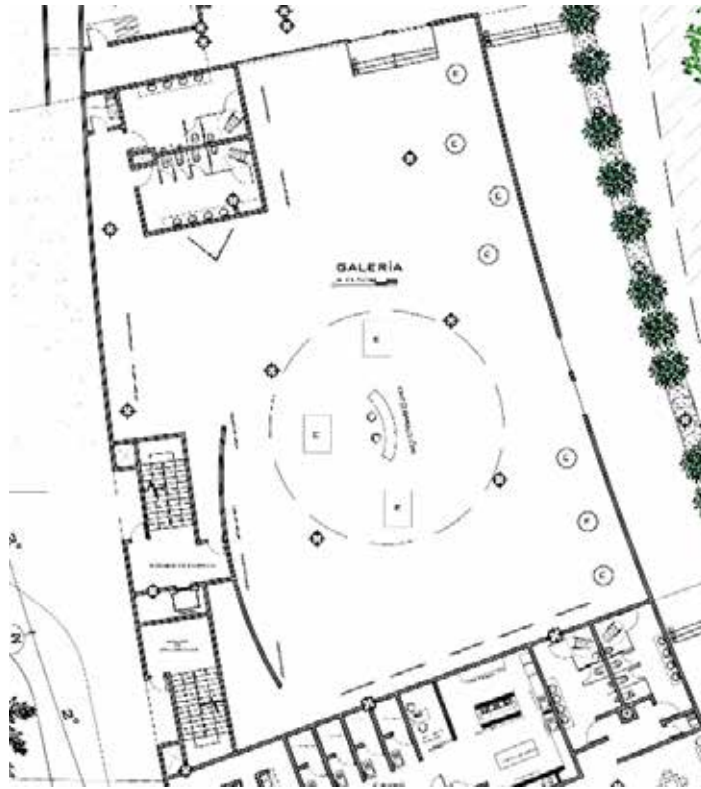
Planta baja, nivel +0.50m. Área de Galería (2017).
